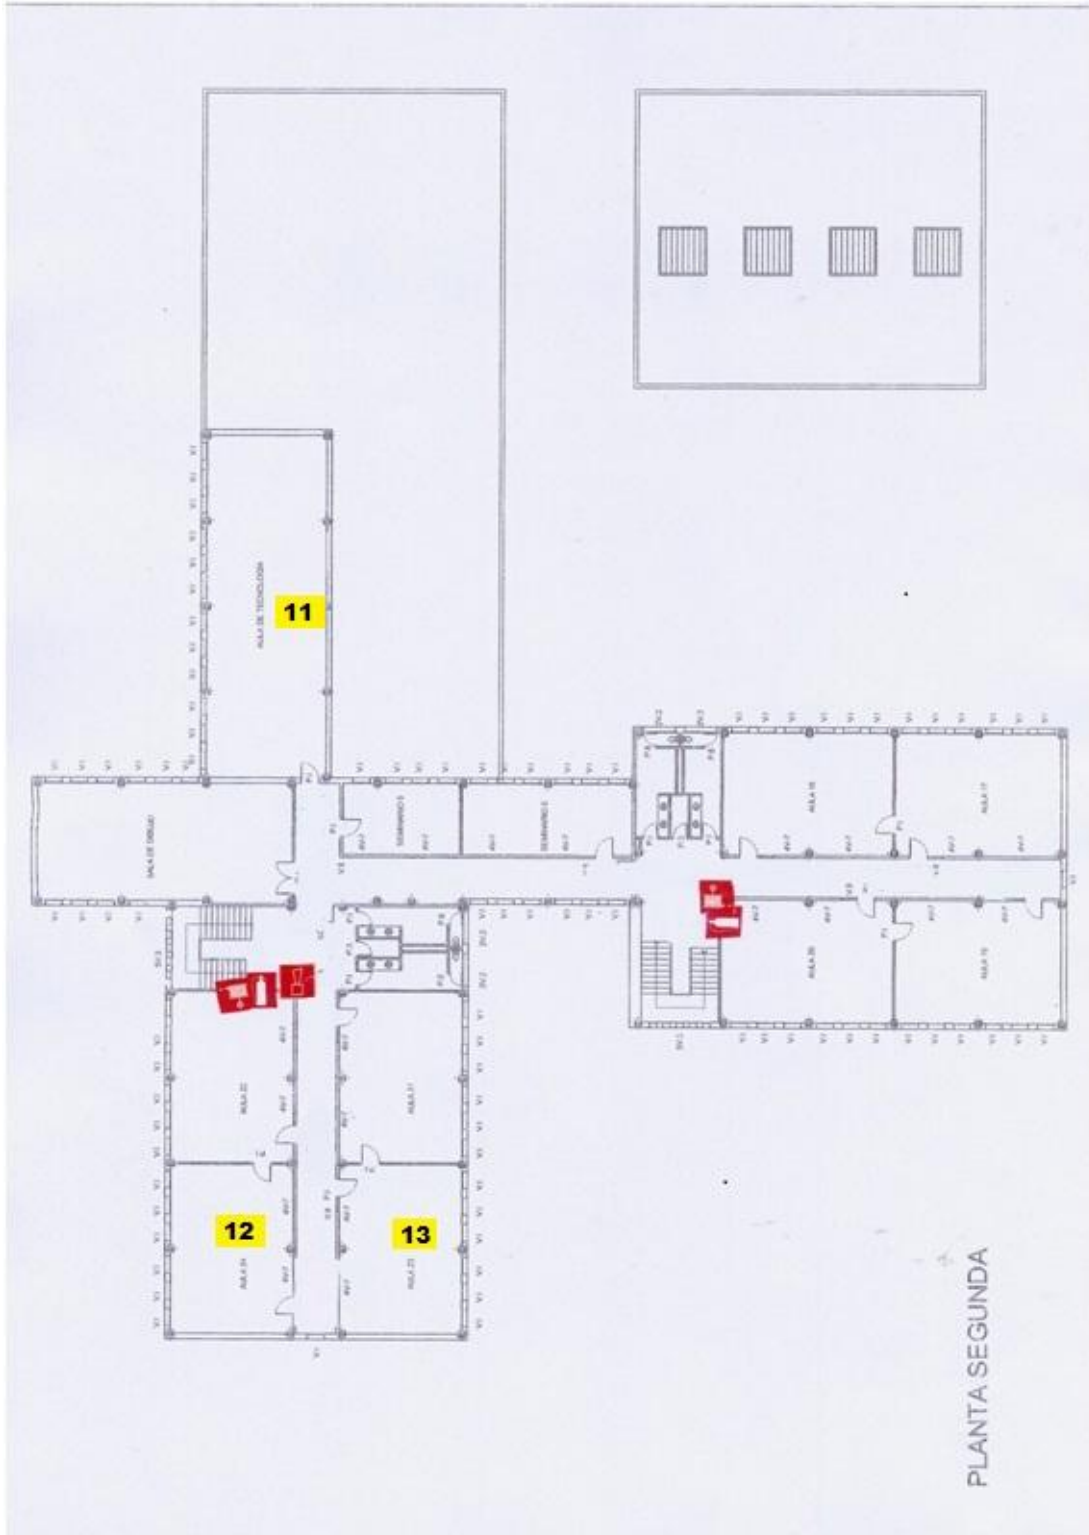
Ubicación elementos e instalaciones de riesgo – Plano planta segunda.
